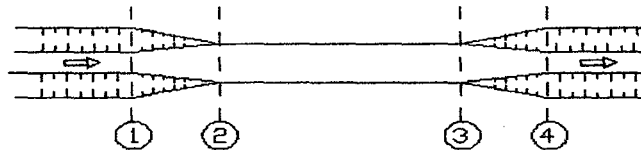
VISTA EN PLANTA DE UN PUENTE CANAL
